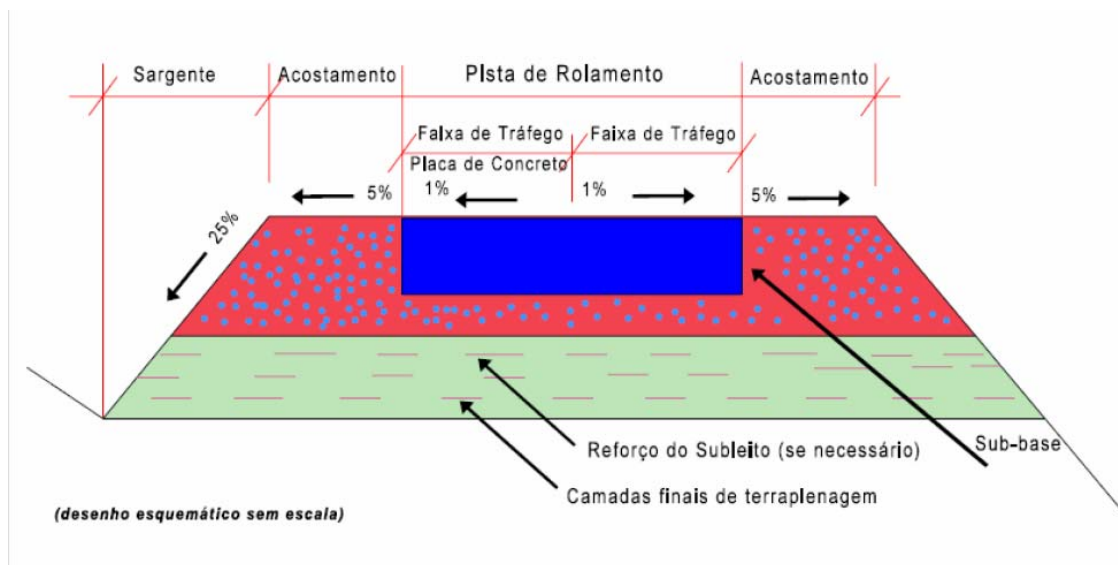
Seção típica de um pavimento rígido. (MARQUES, 2002)
